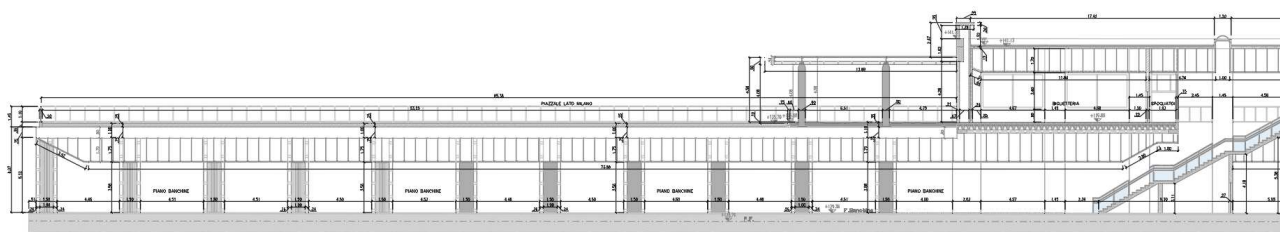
Sezione longitudinale nuovo Piazzale lato Milano
